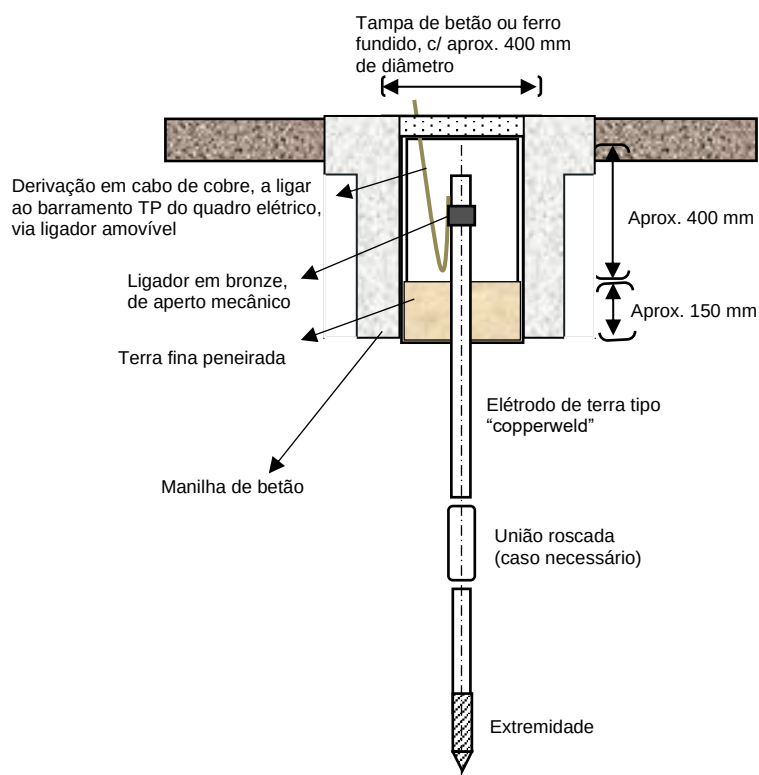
Instalação de eléctrodo de terra de reforço da terra de protecção, considerando pavimento em terra
